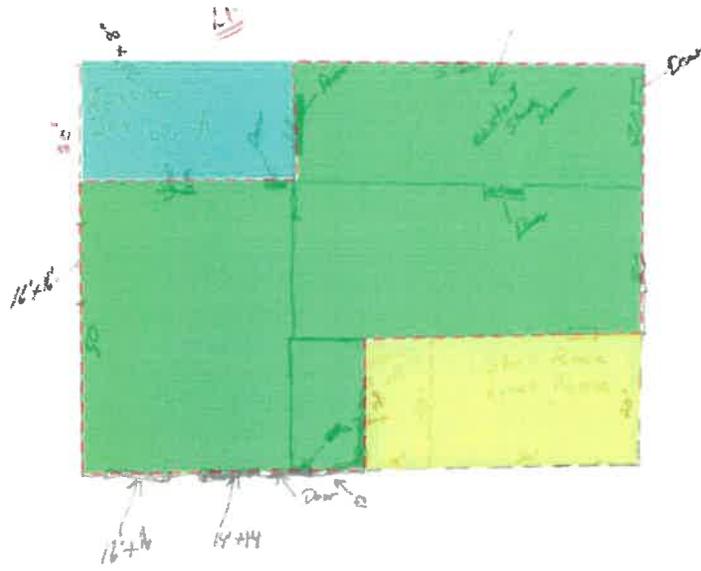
Plan d'agrandissement fourni par le requérant/ Expansion plan provided by applicant.
